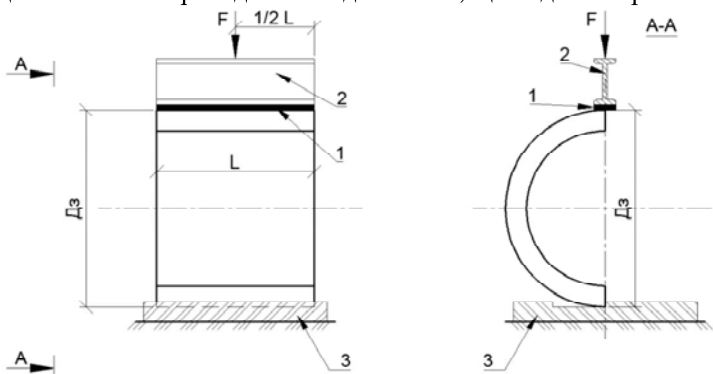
Схема випробування лотка: 1 – гумовий килим; 2 – металева траверса; 3 – нерухома основа
